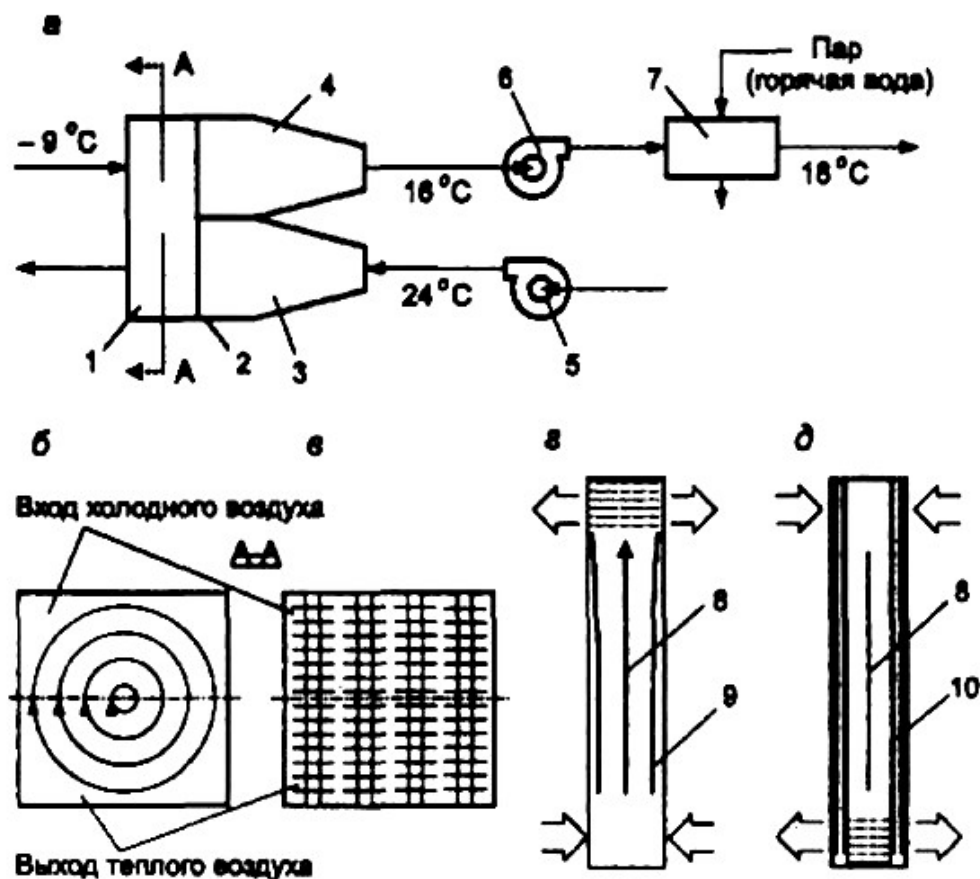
Схема утилизатора теплоты вытяжного воздуха (а) с регенеративной вращающейся насадкой (б) и тепловыми трубами (в) и схемы термосифона (г) к тепловой трубе (д): 1 - вращающаяся теплоаккумулирующая насадка; 2 - корпус;
